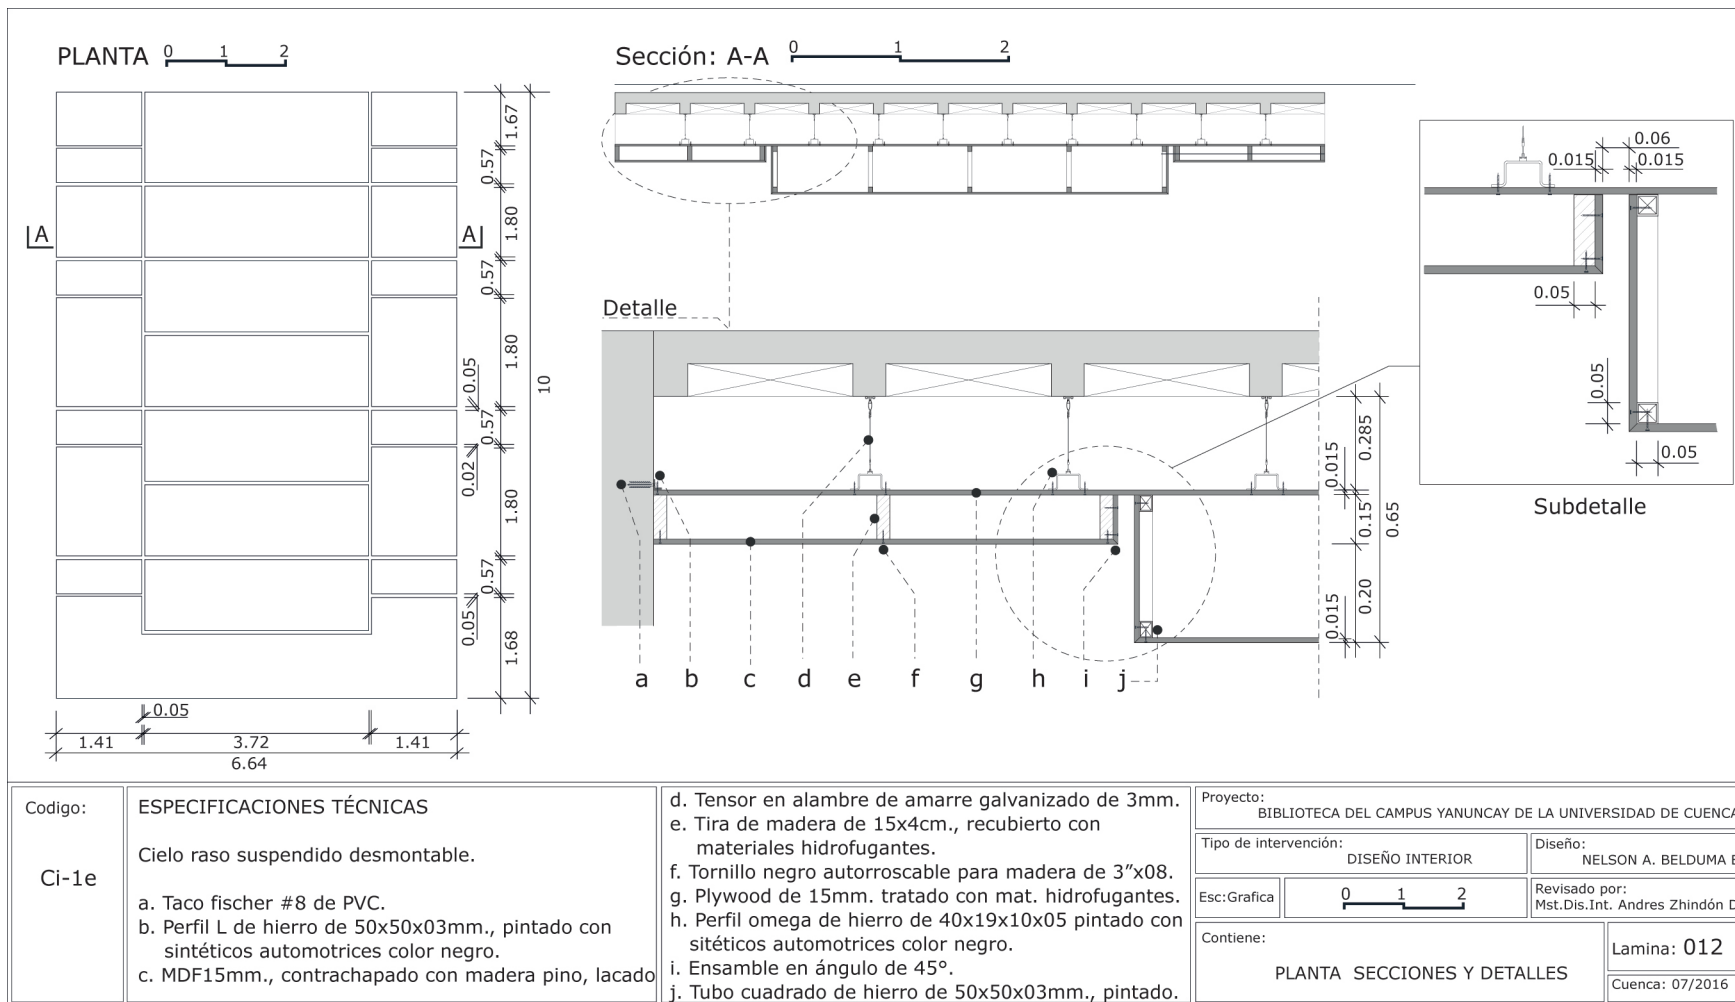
Planta, secciones y detalles. Sala polivalente. Ci-1e.
